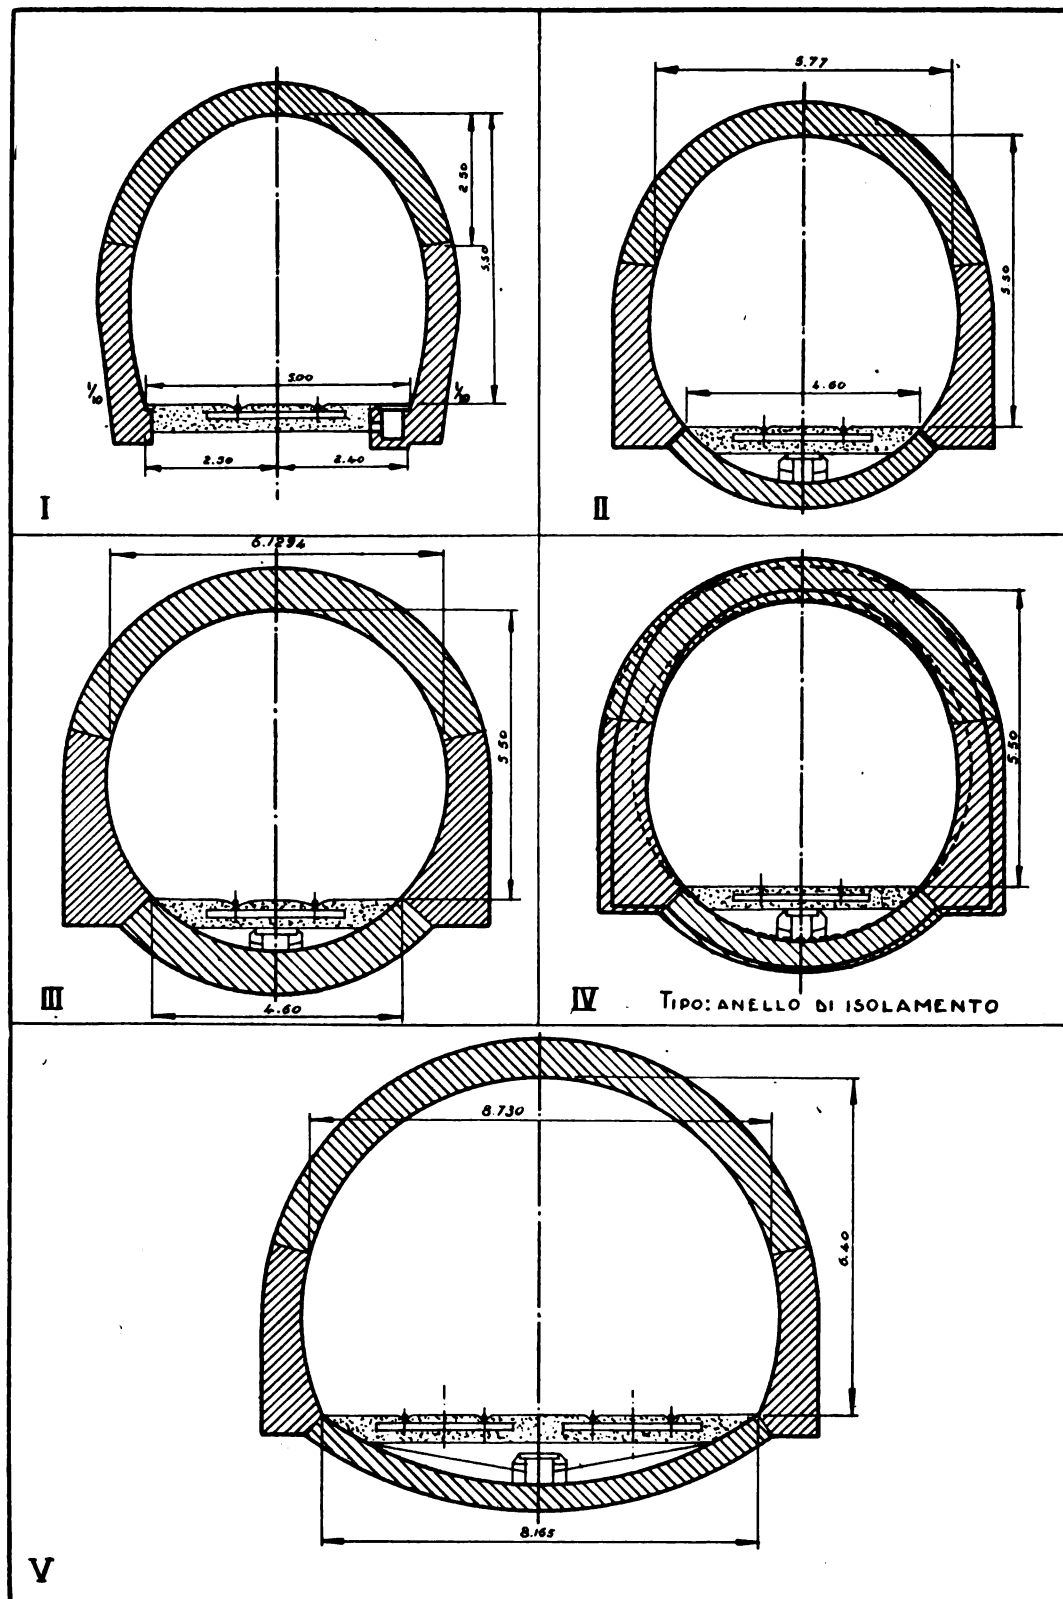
Tipi di rivestimenti murari adottati dalle Ferrovie dello Stato per lavori di rifacimento.
